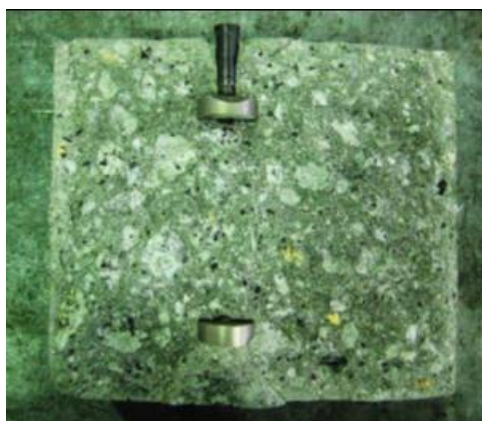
Dispositivos de fixação ao betão, depois da realização do ensaio [72].
